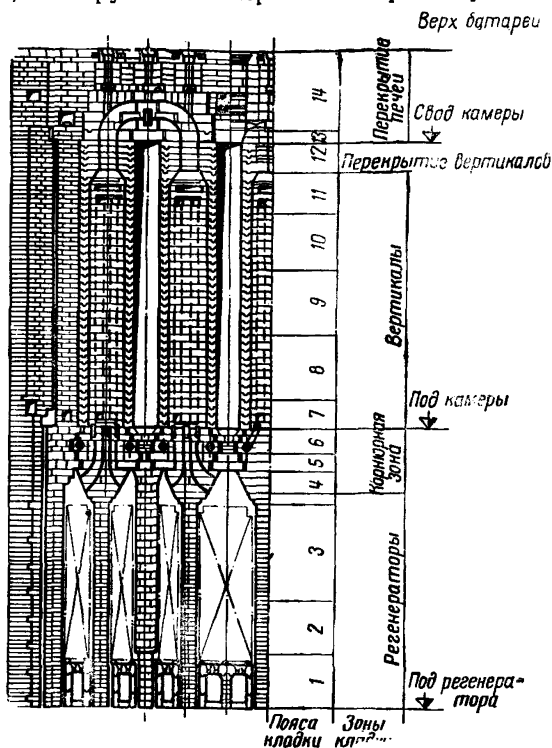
Схема разбивки кладки типовых печей ПК-2к на зоны и пояса
